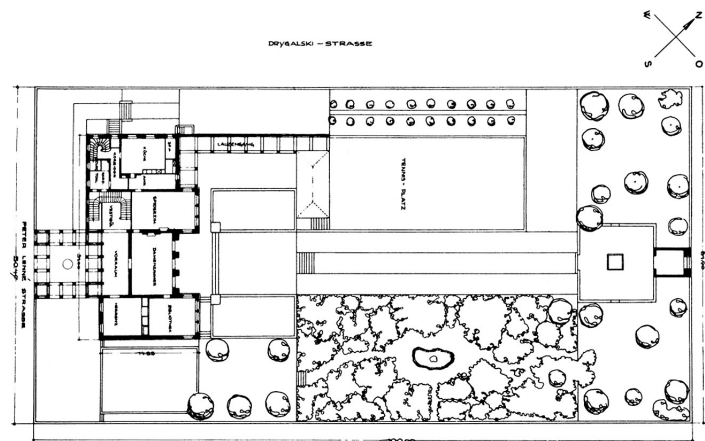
P. Behrens, *Villa Wiegand*, *Grundriss mit Garten*, Berlin 1911-12
